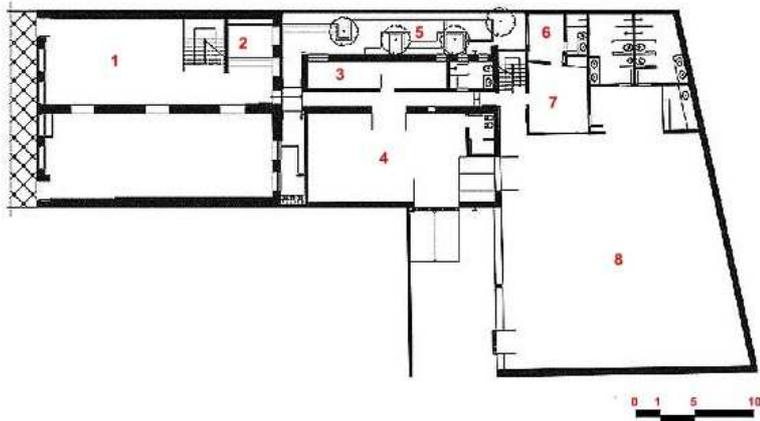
Planta pavimento térreo (Fonte: ARCOWEB)
